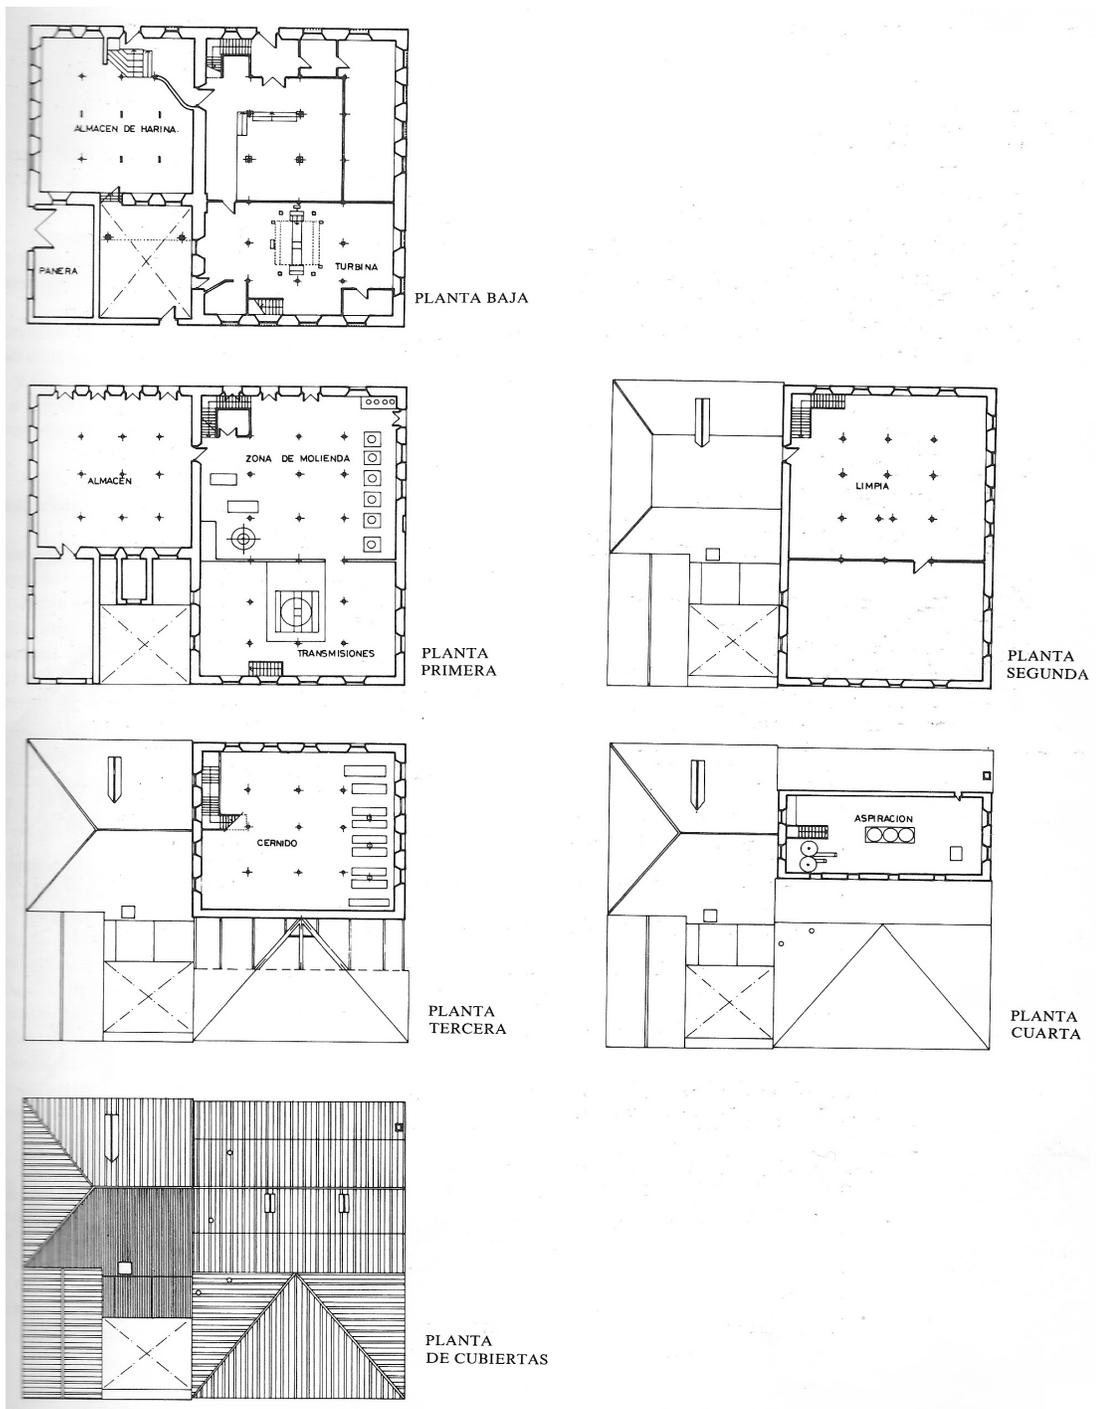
Distribución en planta de la fábrica de harinas “San Antonio”. En la planta baja se ven la turbina y el almacén de harina, en la primera la zona de molienda y las transmisiones en la segunda planta la limpia, en la tercera el cernido y en la cuarta planta la aspiración. (CARRERA DE LA RED, Miguel Ángel: 1990: 114-117).
